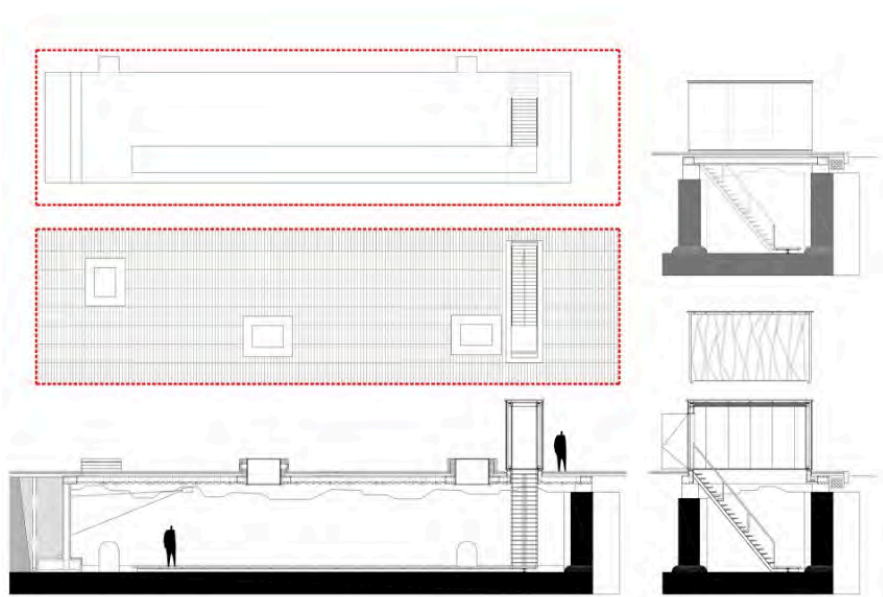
Planta y secciones de la intervención arquitectónica. (<http://www.archdaily.com.br/br/01-40215/intervencao-na-plaza-de-la-pescaderia-sevilha-marinas-arquitectos-asociados>)
